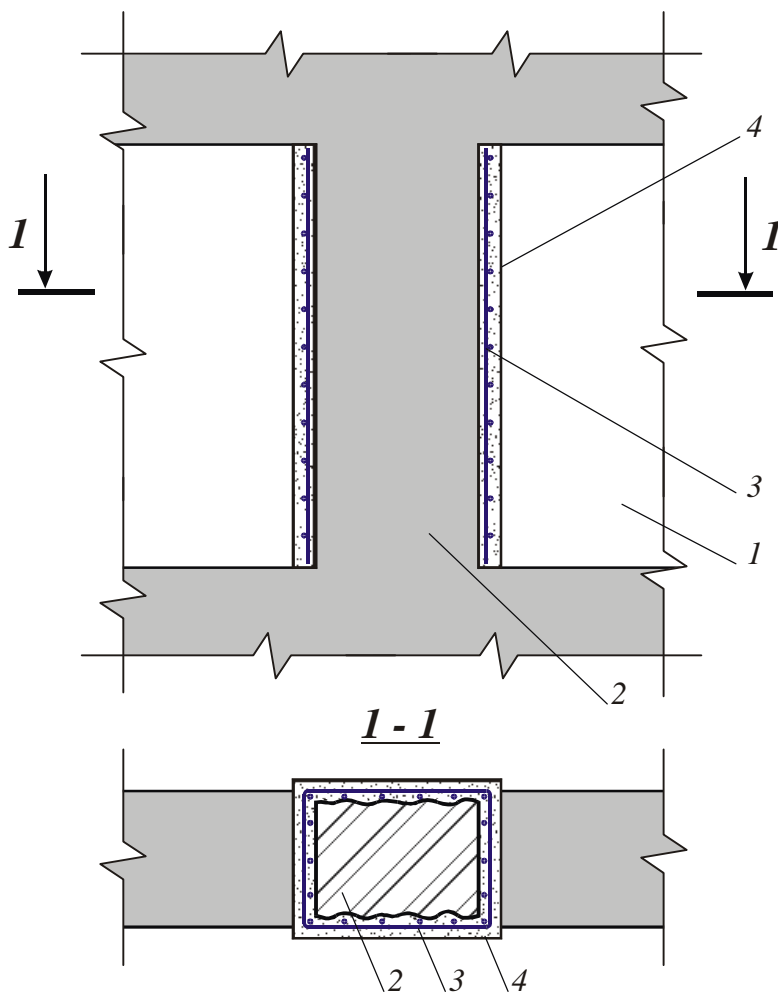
Устройства железобетонной обоймы с увеличением сечения простенка:
